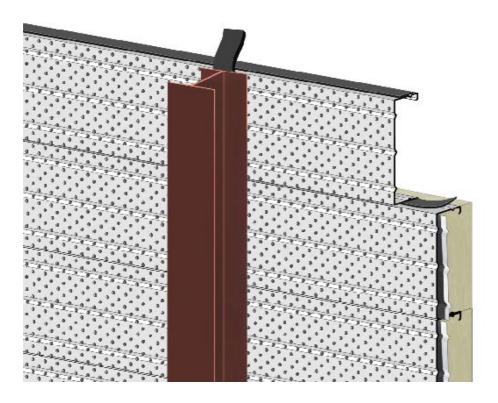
er – Mise en place du joint d'étanchéité SUPER ETANCOPLAST sur plateaux métalliques perforés
